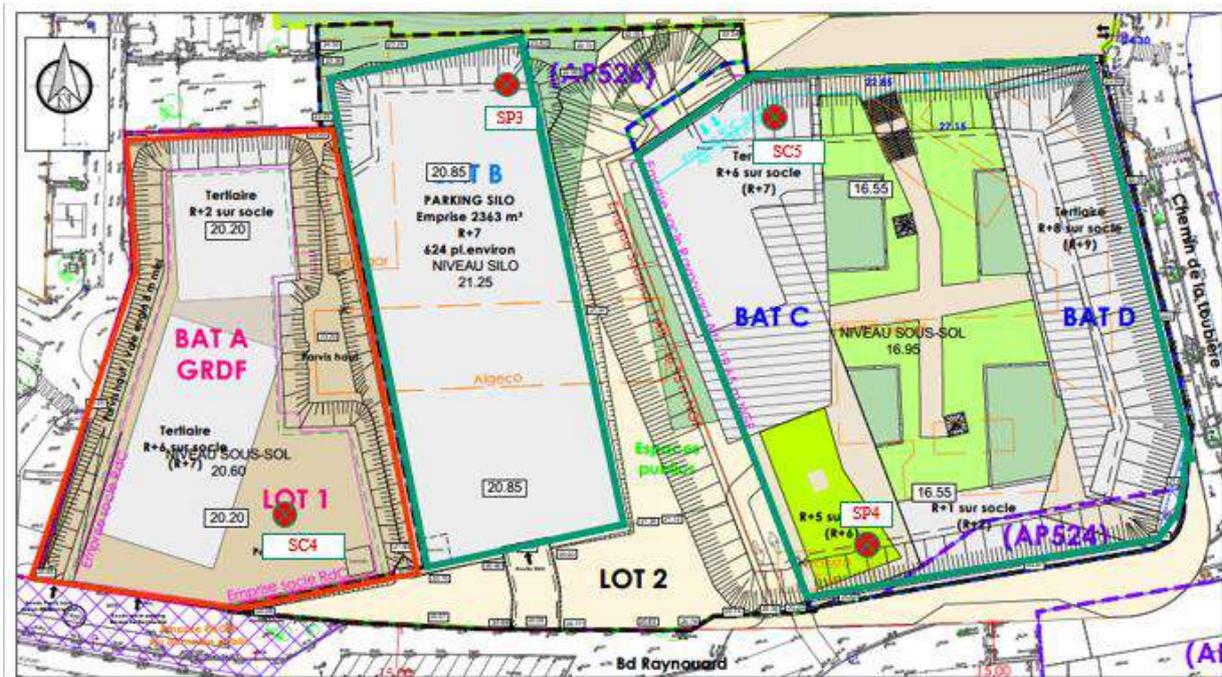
localisation des ouvrages géotechniques sur fond de projet
